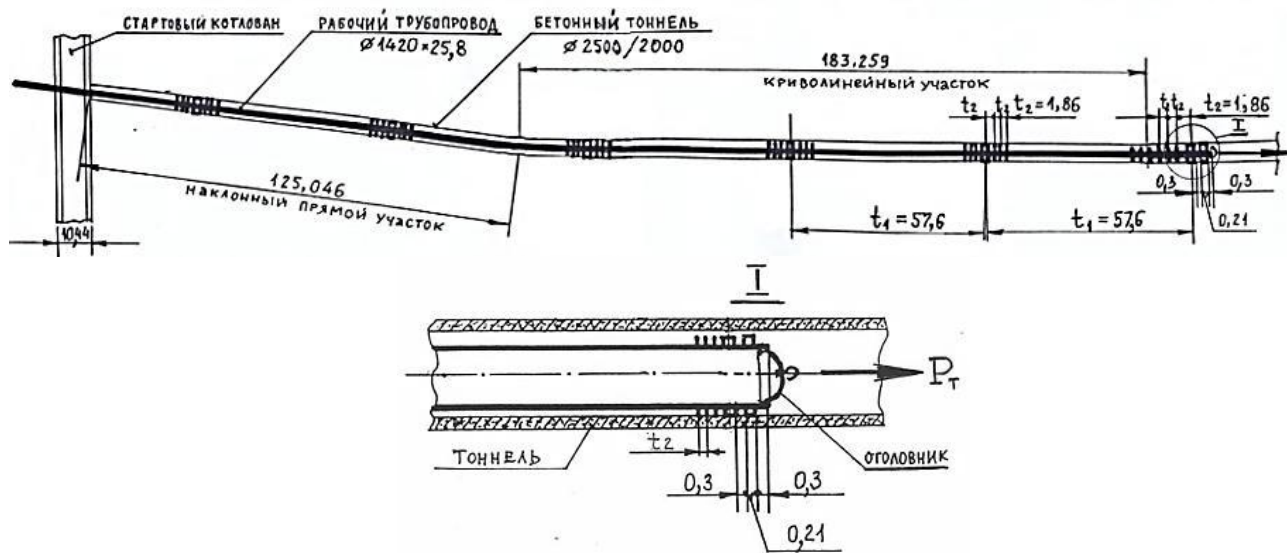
Схема протягивания рабочего трубопровода в бетонном тоннеле на переходе через р. Неву на участке Грязовец-Выборг (597—917 км) Северо-Европейского газопровода
